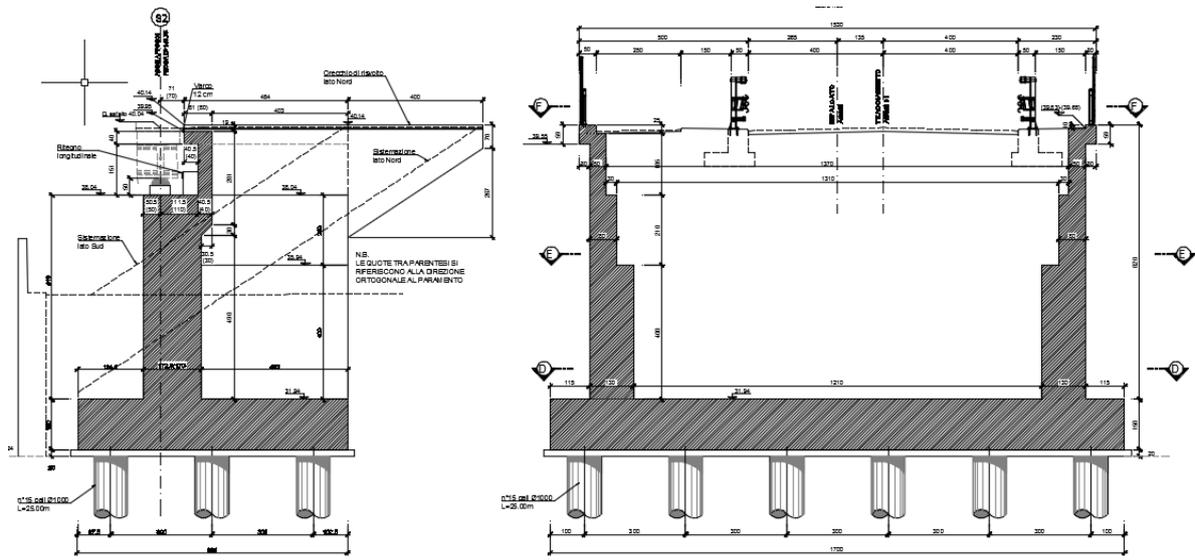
Sezioni longitudinale e trasversale spalla S2
